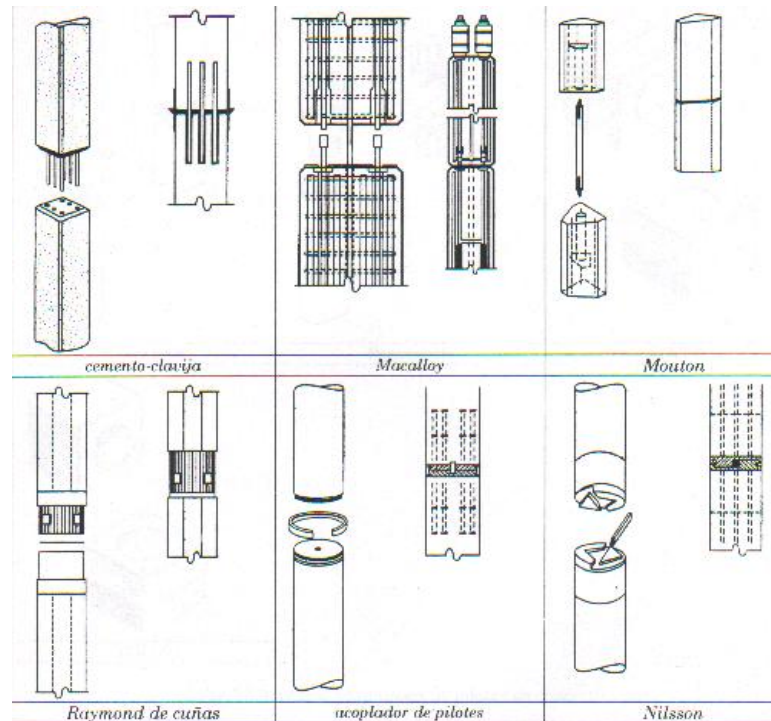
Juntas para unión de pilotes de concreto. (Bruce and Hebert, 1974; Santoyo, 1996).
